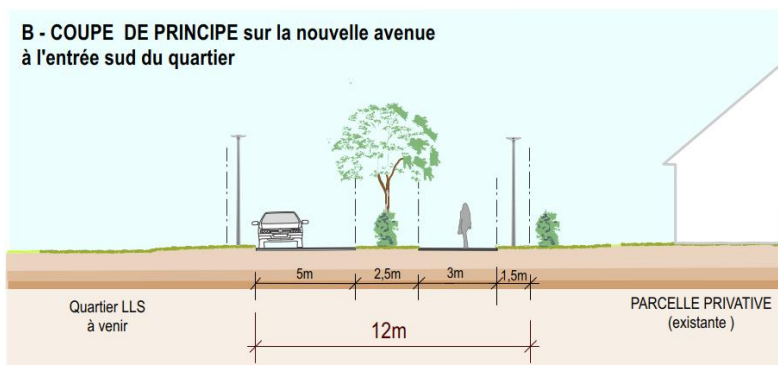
Coupe de principe sur la nouvelle avenue, OAP PLU
